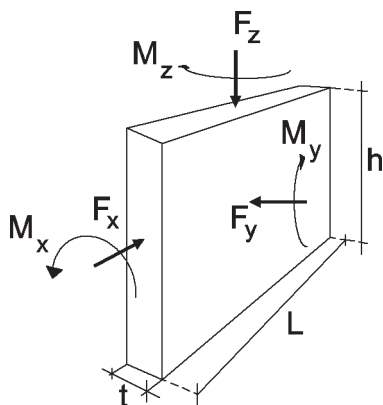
Pannello murario e schema delle azioni secondo i tre assi di riferimento
